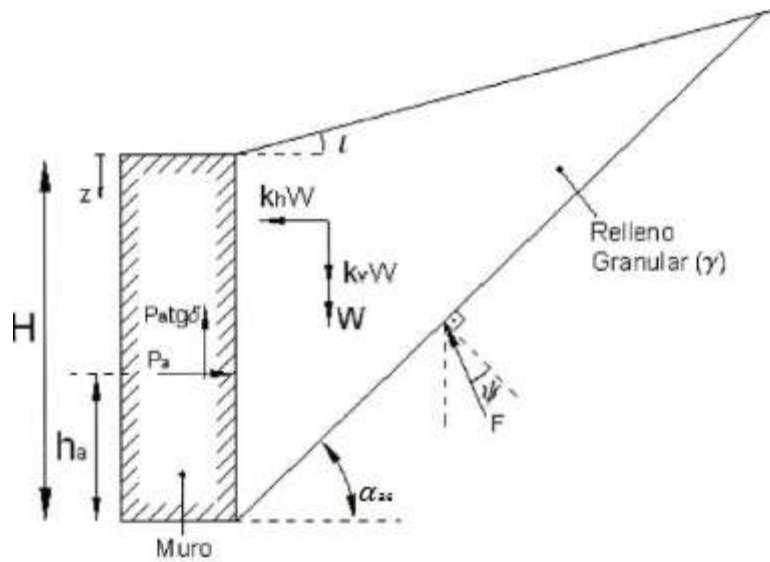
(Modelo de muro utilizado por Dubrova, 1963)
